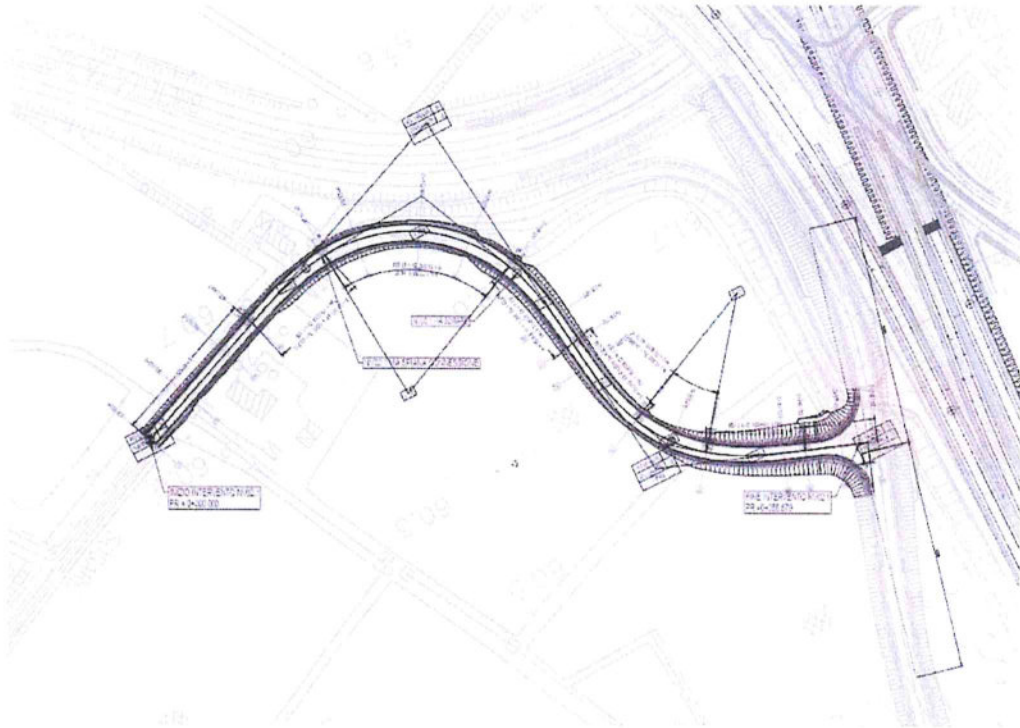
NV02.1 – Stralcio planimetrico su rilievo Via Sogare
